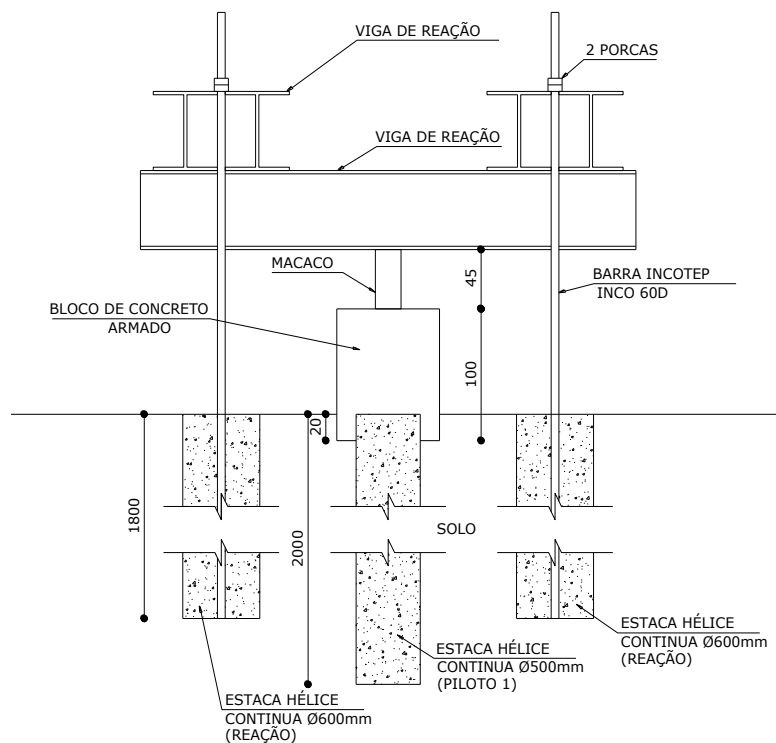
Vista lateral das provas de carga estáticas (dimensões em mm).
